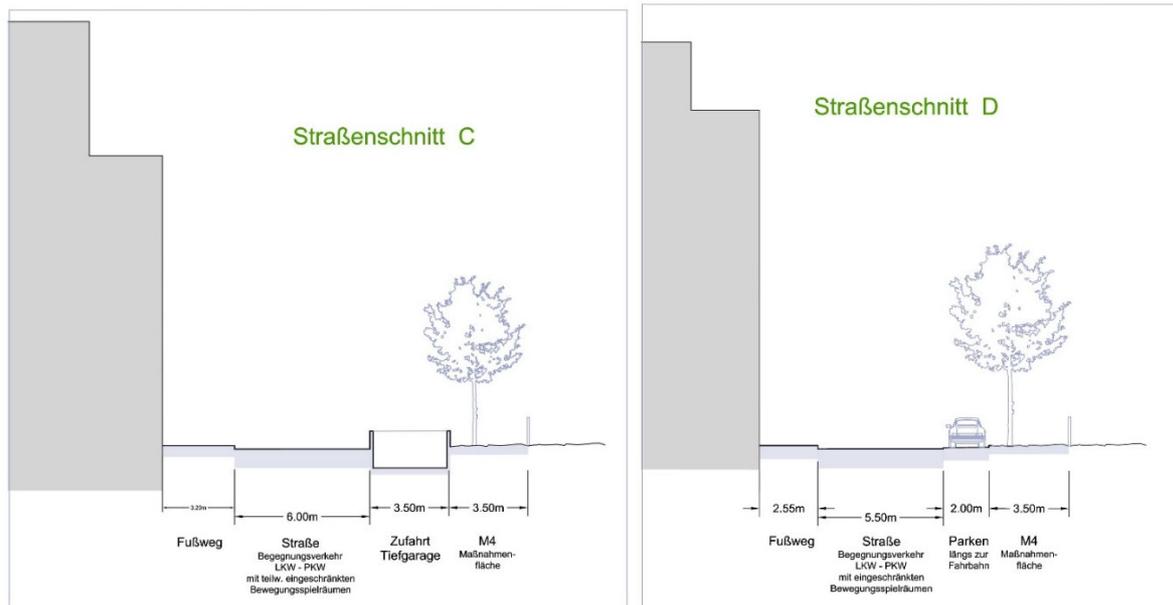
, 8: beispielhafter Schnitt der Erschließungsflächen im Plangebiet: Straßenschnitt C, D
